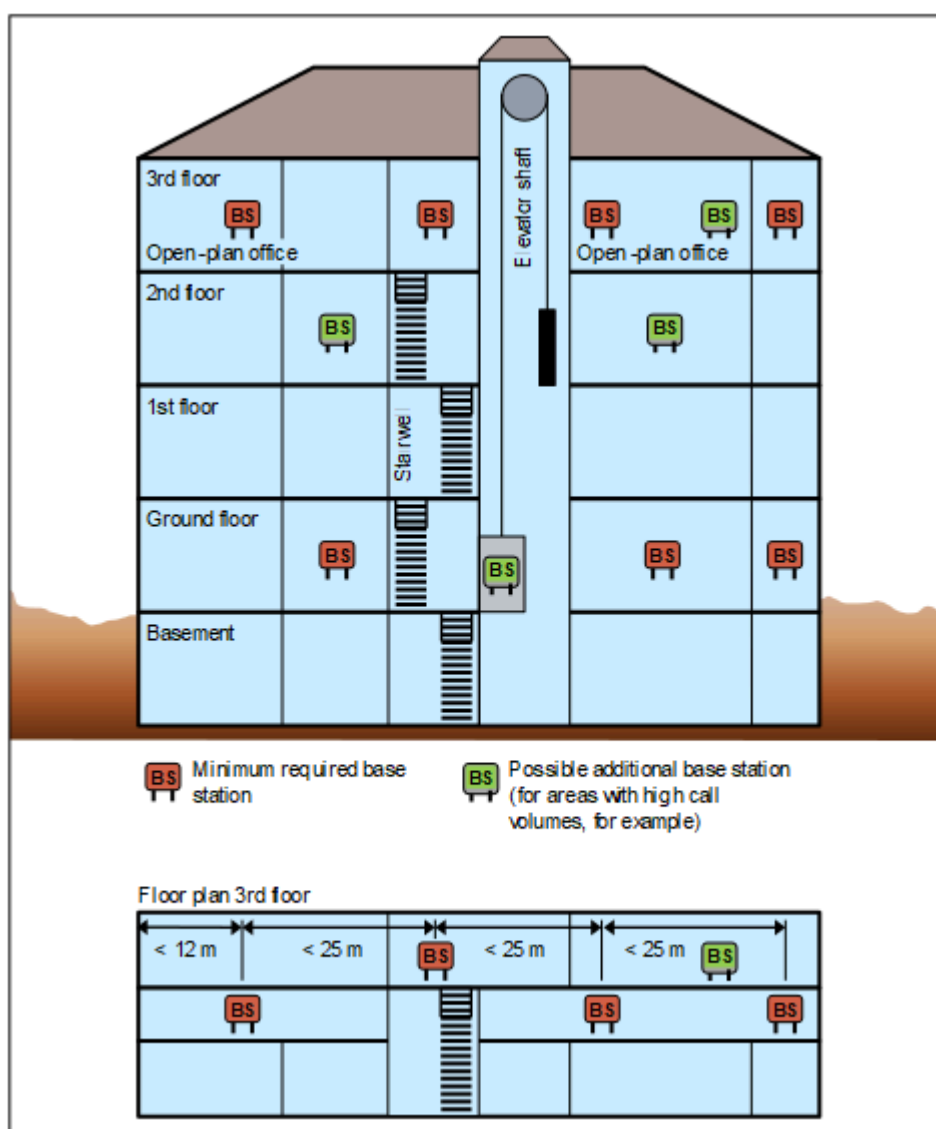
Ejemplo de posicionamiento de extensiones base en edificios de hormigón armado con paredes divisoras de hormigón y acero
